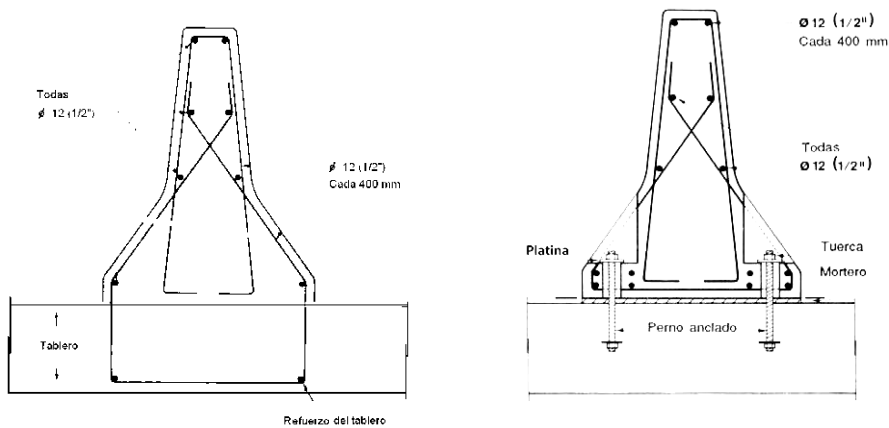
Barreras dobles ancladas en una losa de puentes
